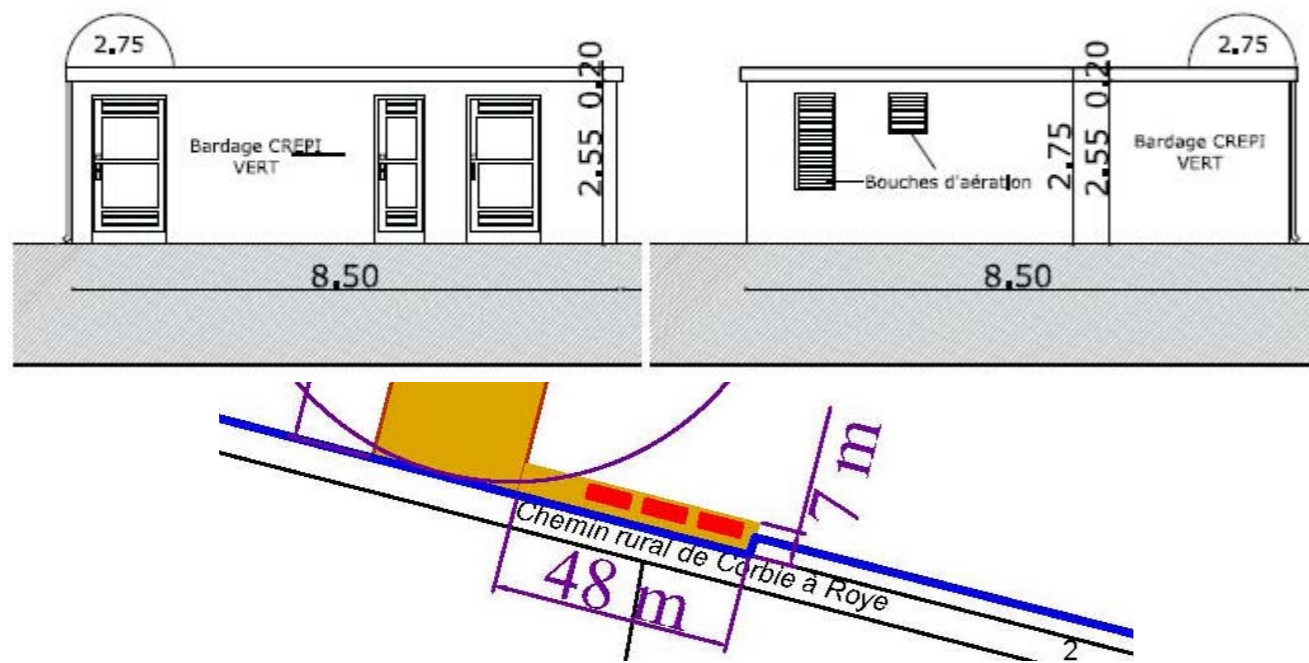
Plan de façade et plan de masse des postes de livraison du parc du Moulin Blanc
